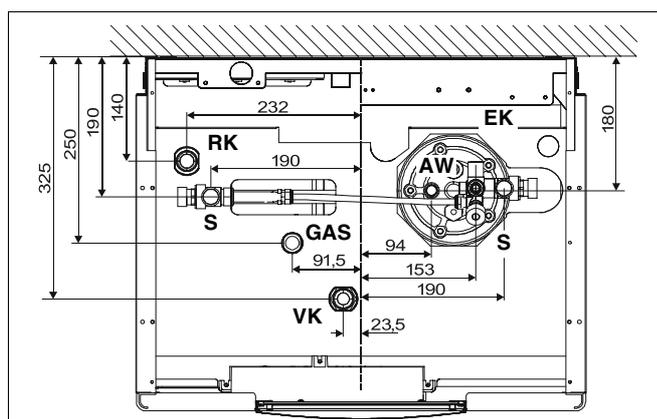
Vista da sopra della posizione dei collegamenti (misure in mm)
